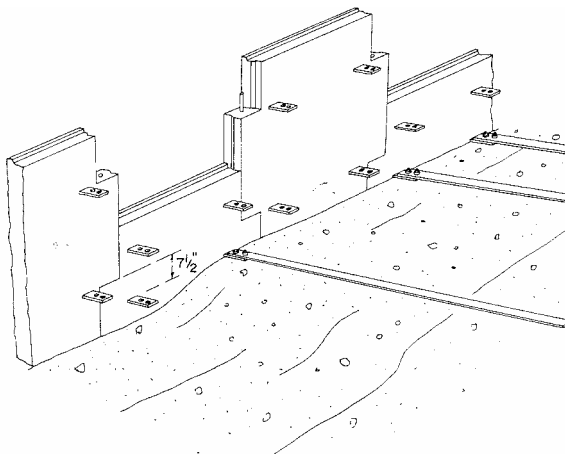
Disposición de amarres de pletinas en elementos prefabricados en muros de tierra armada. (Ingold, 1982).
